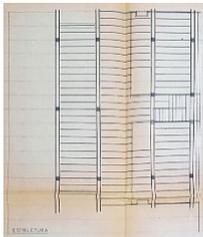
Planta baja dúplex Estructura B-2-4. 1964. Fuente: Archivo Municipal da Coruña
